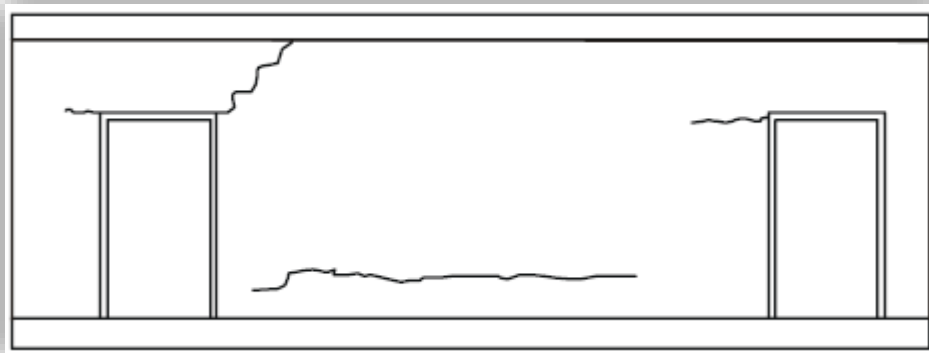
Fissuras em parede causadas por deformação estrutural.
